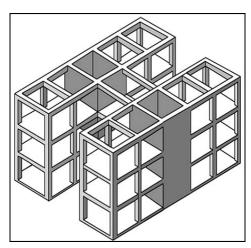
Muros estructurales Interiores. (fuente: Evaluación, reparación y rehabilitación de estructuras de concreto)
